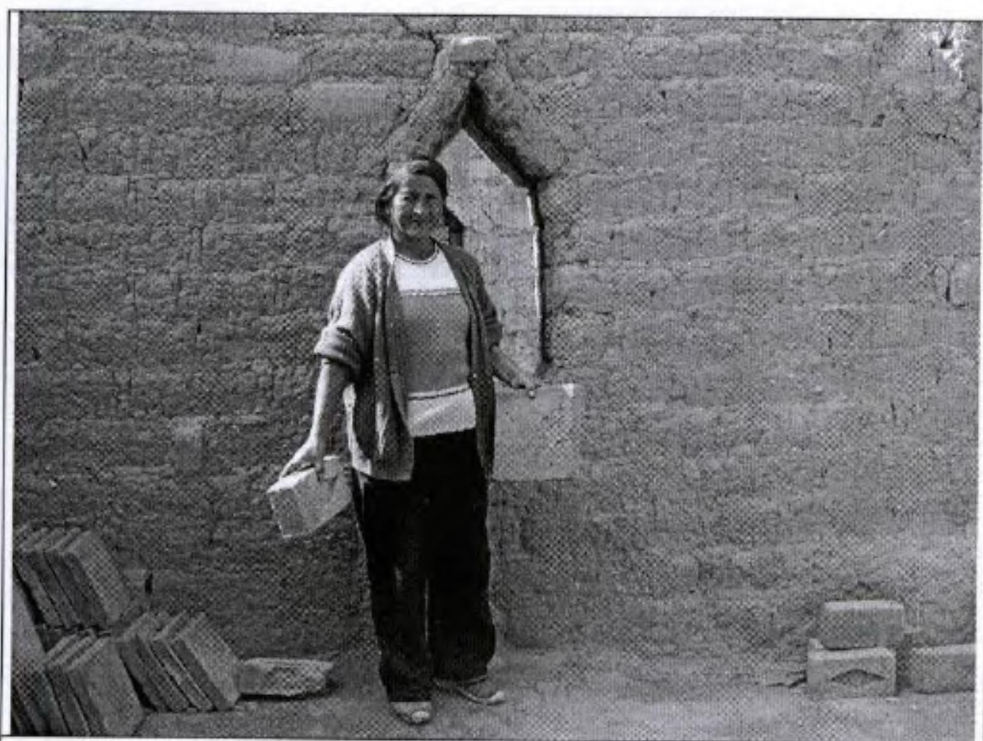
Ladrillos tipo refractarios (panadería) – Condorsinja – Jauja – Junín – Noviembre 2005
